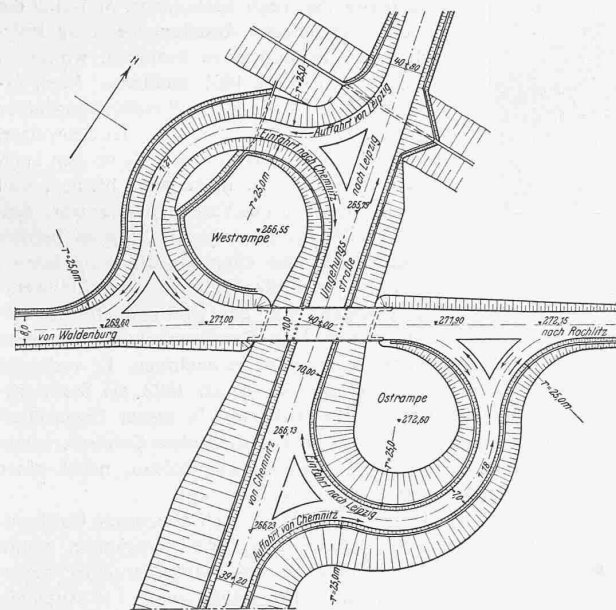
Ueberführung der Nebenstrasse Rochlitz-Waldenburg über die Hauptstrasse Chemnitz-Leipzig, Anschlüsse durch Rundrampen. — 1 : 2000.
